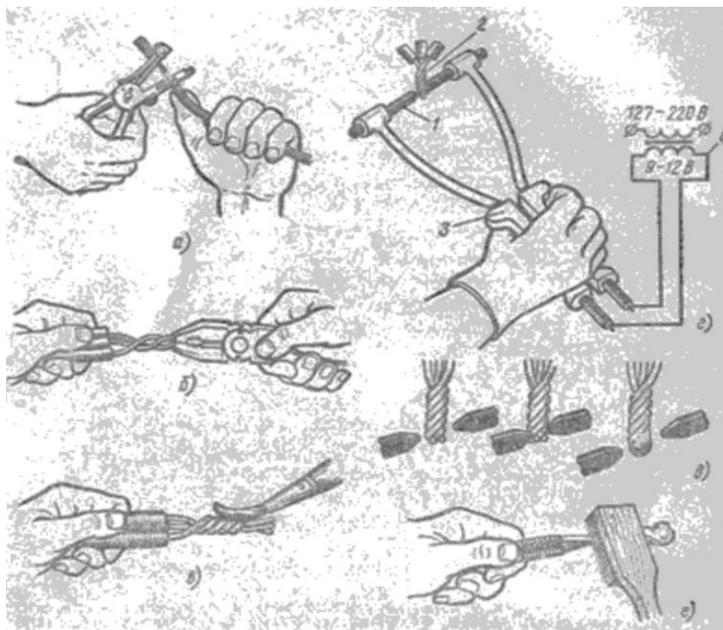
Соединение алюминиевых жил в клещах с двумя угольными электродами: а — снятие изоляции; б — зачистка и скрутка жил; в — покрытие флюсом; г и д — сварка скрутки; е — обработка мест сварки; 1 — угольный электрод; 2 — скрутка алюминиевых жил; 3 — двухэлектродные клещи; 4 — понижающий трансформатор.
